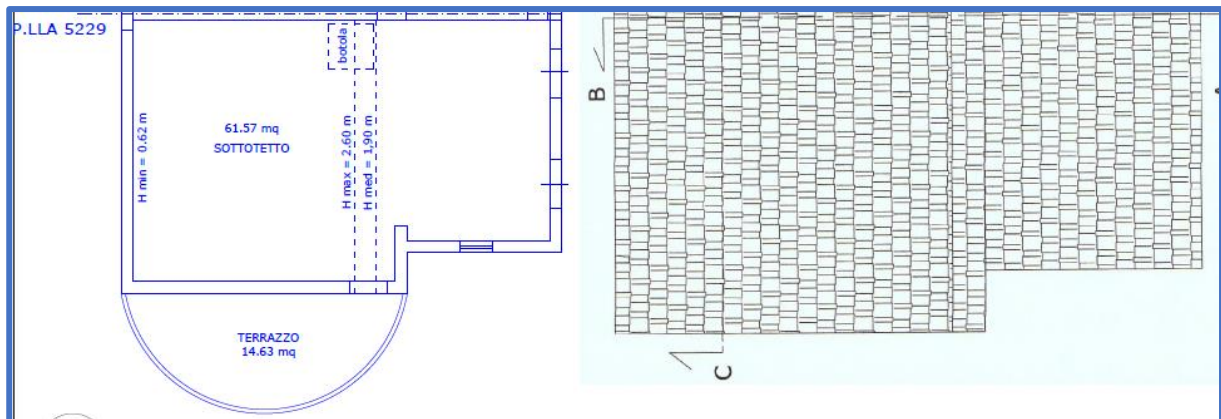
Fog. 175 P.lla 5229 sub 1 – sub 2 Piano Sottotetto – Sovrapposizione P.E. 13/2004
